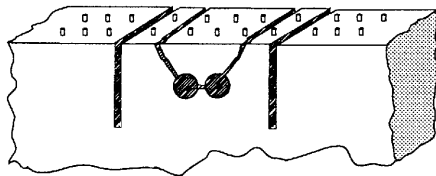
Presswerkzeuge zu nahe zusammen
